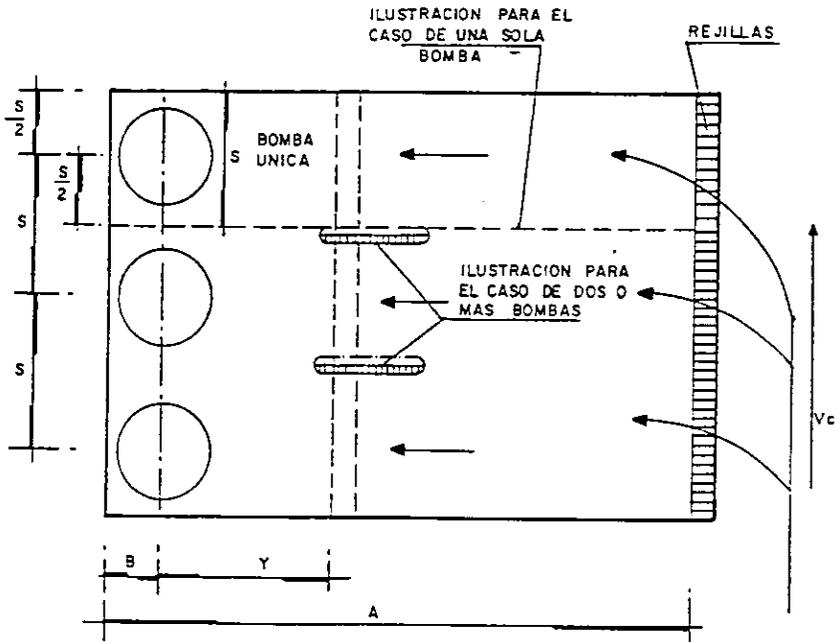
PLANTA DE UN CÁRCAMO DE BOMBEO
